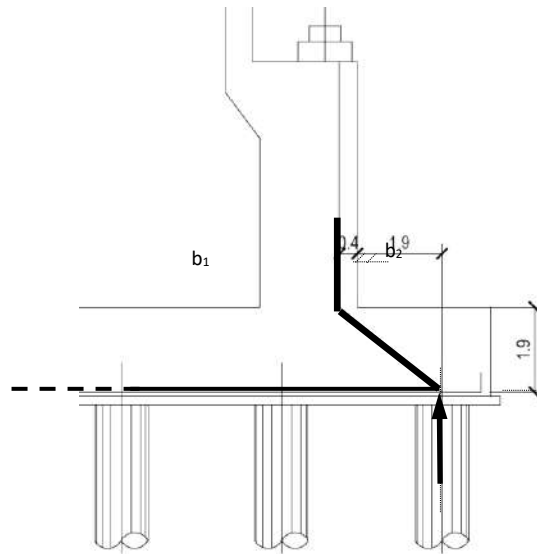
Schema strut and tie suola anteriore e schema diffusivo planimetrico
